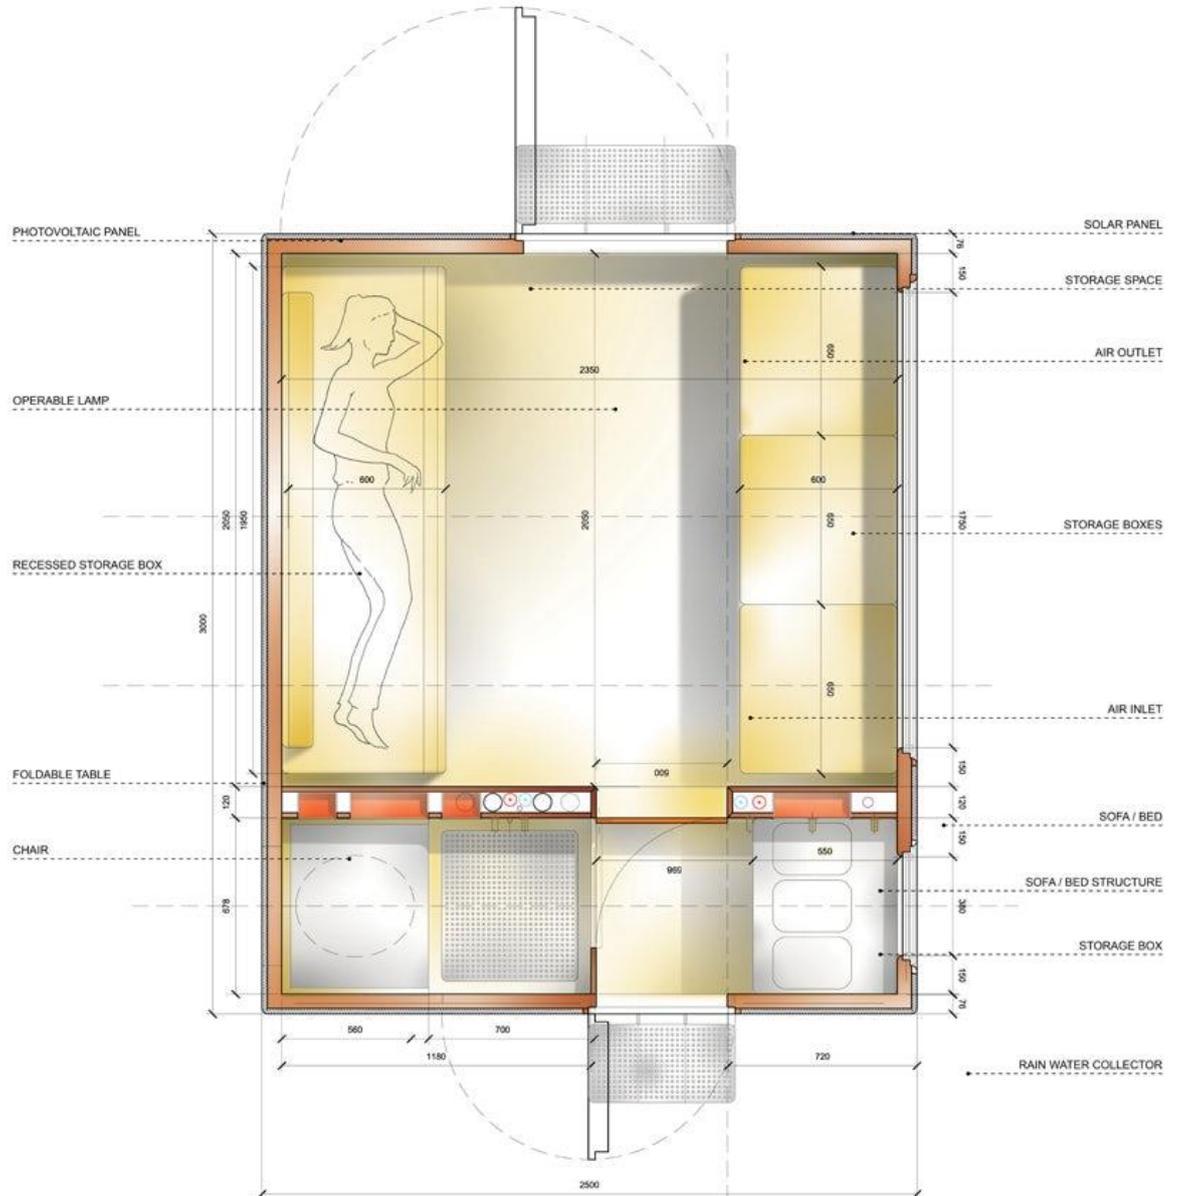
Plan du logement Diogène (RPBW Architects, 2019)
